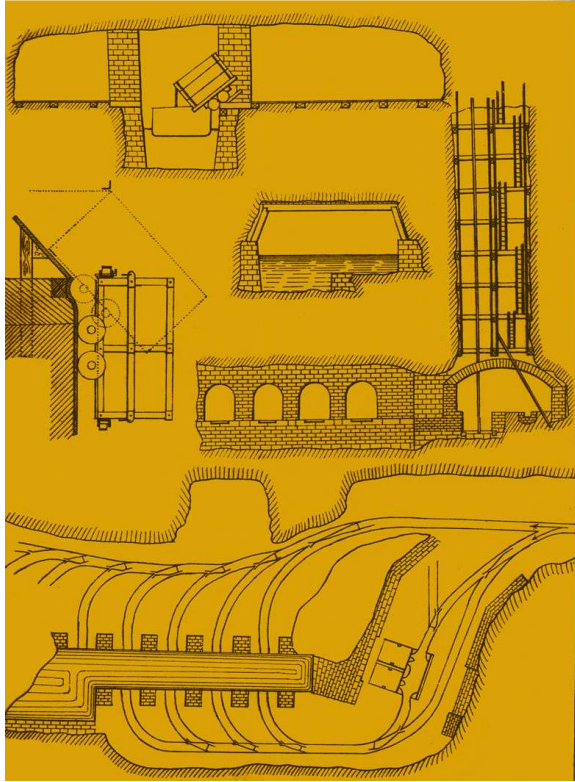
Detalle de carga, sección del pozo, sección del canal y planta de la zona de carga
